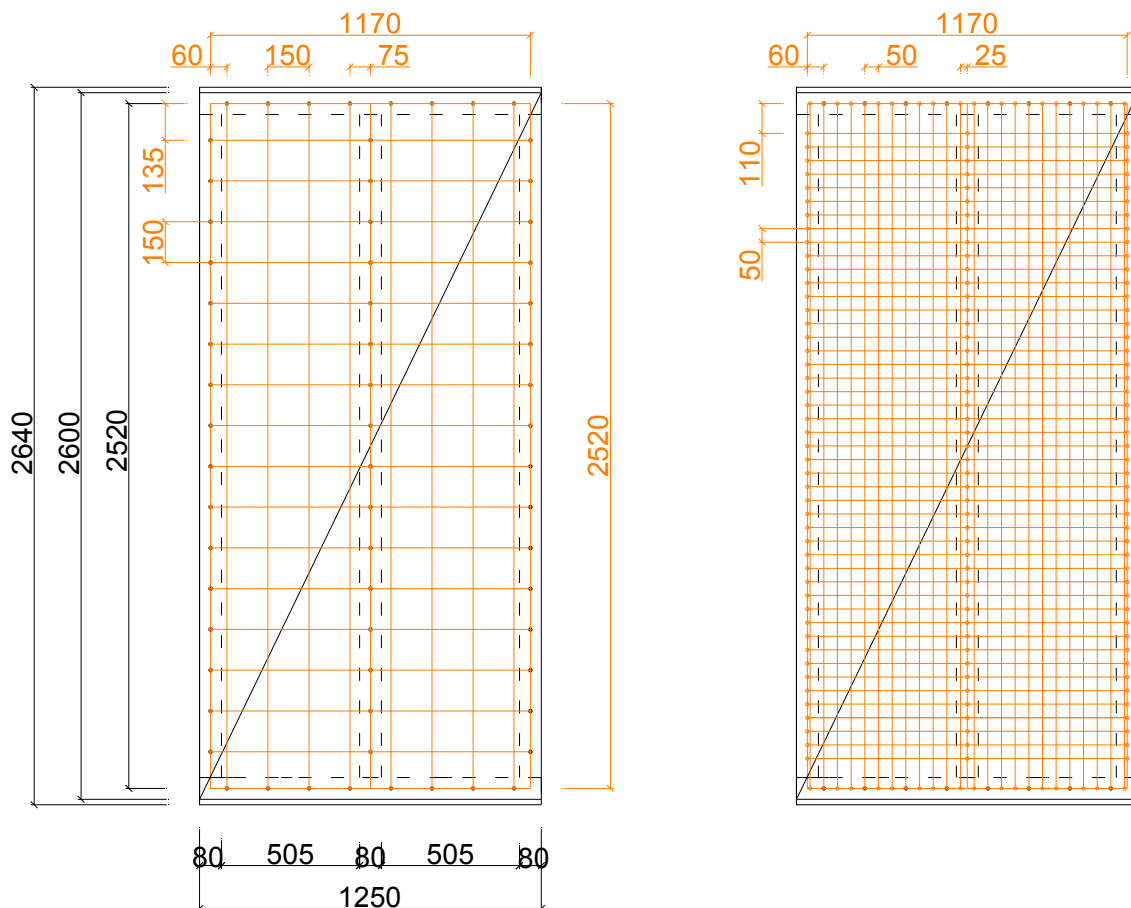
Wandscheibenaufbau im Versuch und gewählte Geometrie für die Berechnung, Verbindung Rippe-Beplankung mit Schrauben (links) und Breitrückenklammern (rechts); (Maße in mm)
